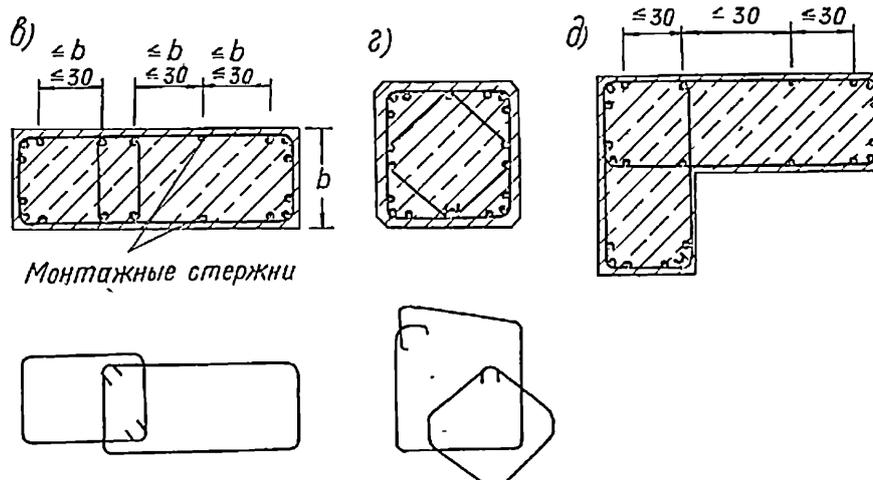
3. Охват хомутом нескольких продольных стержней и примеры по расположению хомутов
